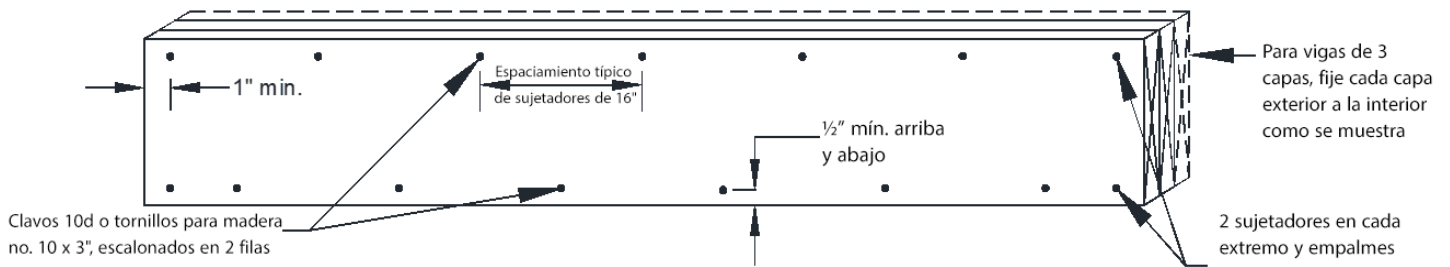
FIJACIÓN DE LA CAPA DE LA VIGA
